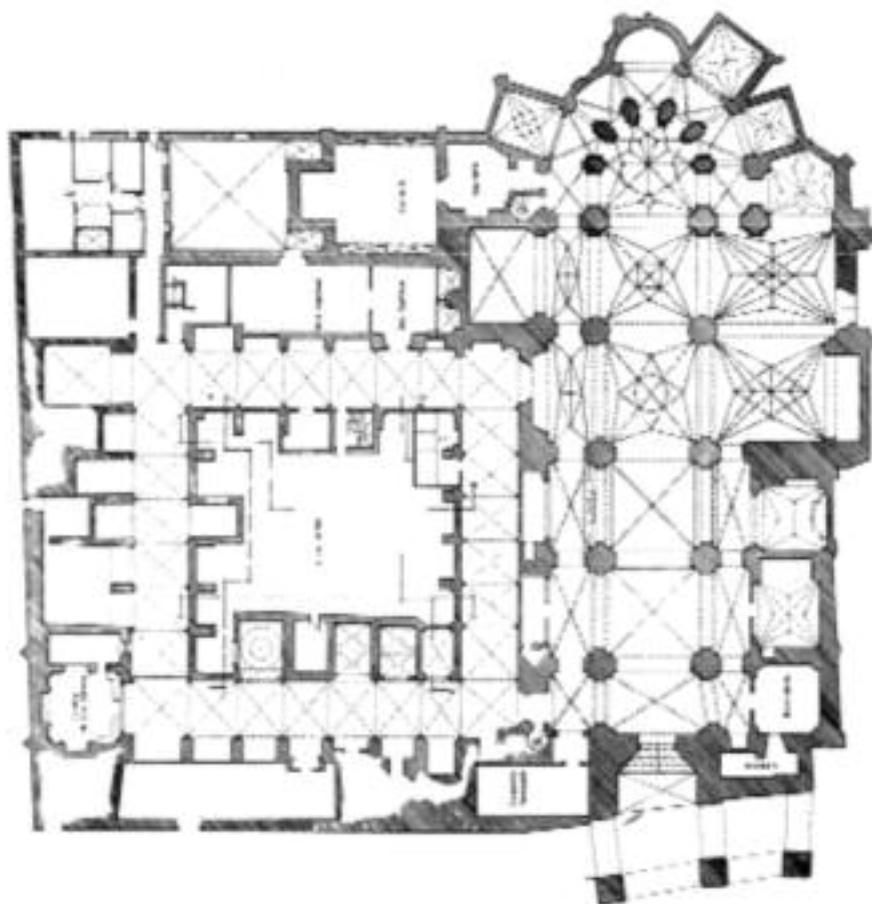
Santo Domingo de la Calzada. Planta de la catedral antes de las restauraciones del claustro
